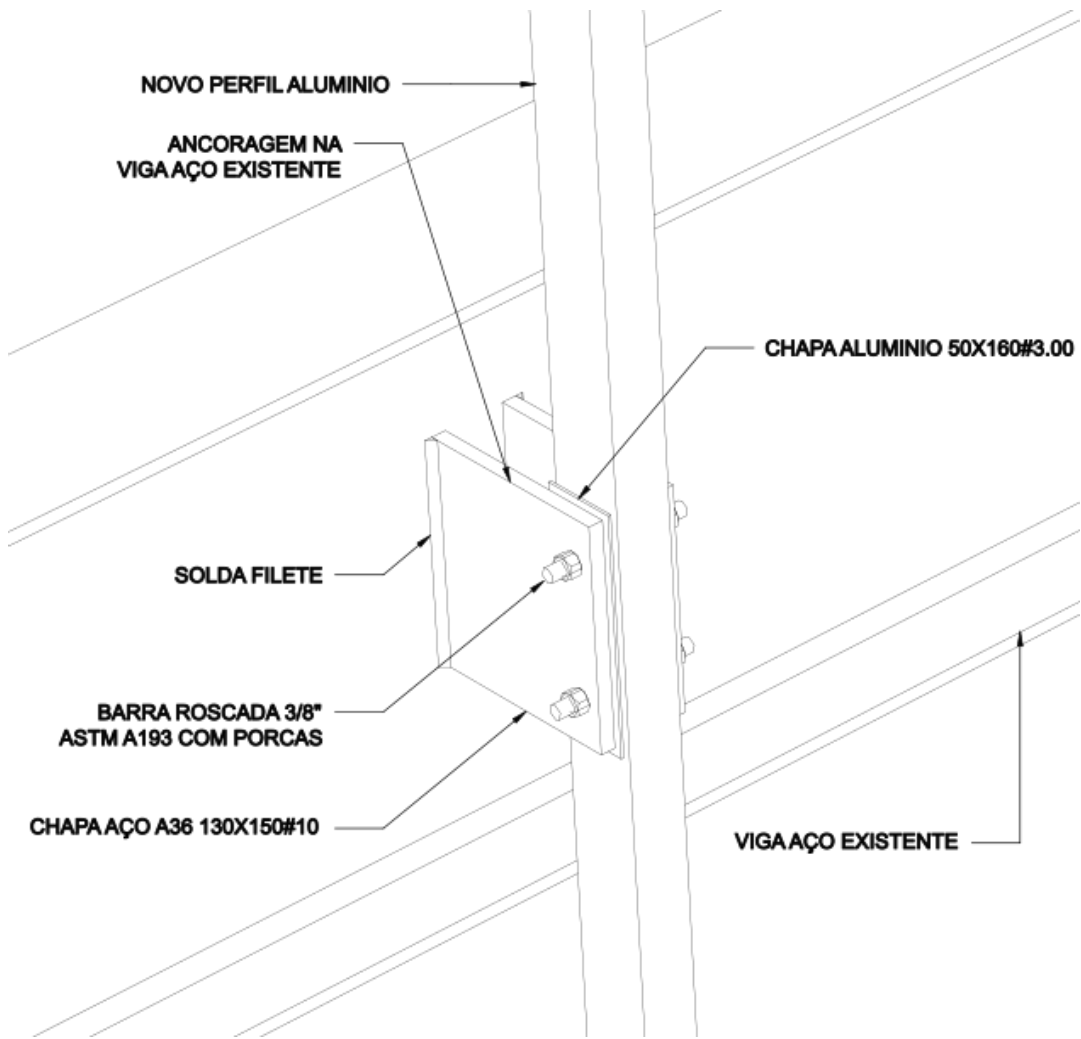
Detalhes da fixação da subestrutura de alumínio da estrutura de aço existente.
